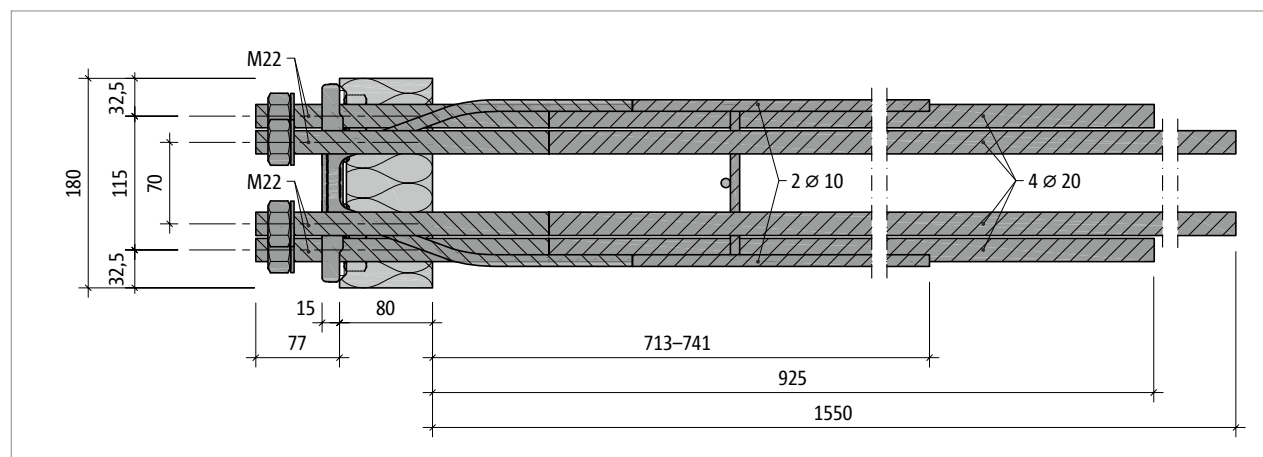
Schöck Isokorb® T type SK-MM2-VV1 : vue en plan
